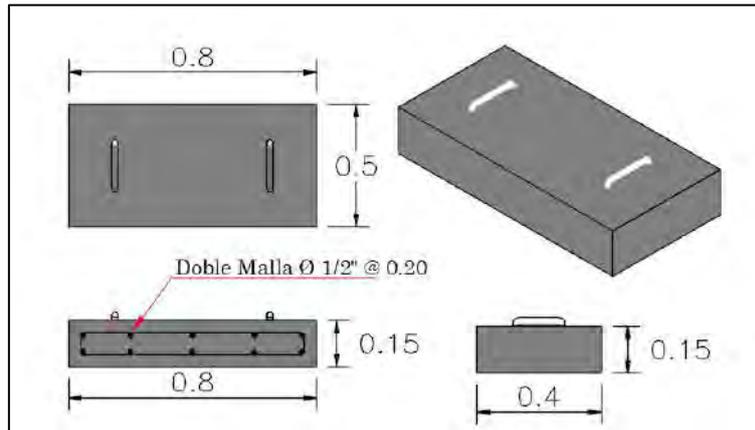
Detalle de las tapas de concreto a usar en el proyecto
